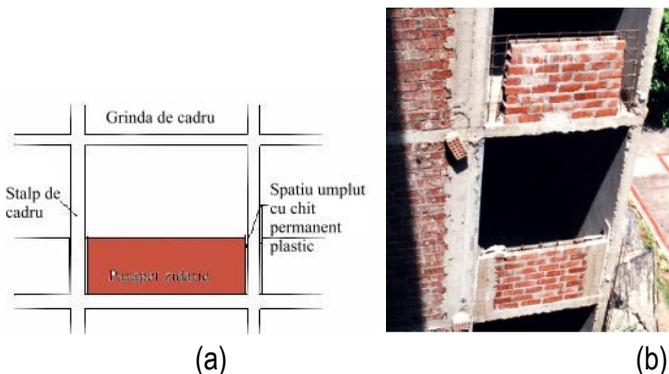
Izolarea zidăriei parapetilor de cadrul de beton armat
